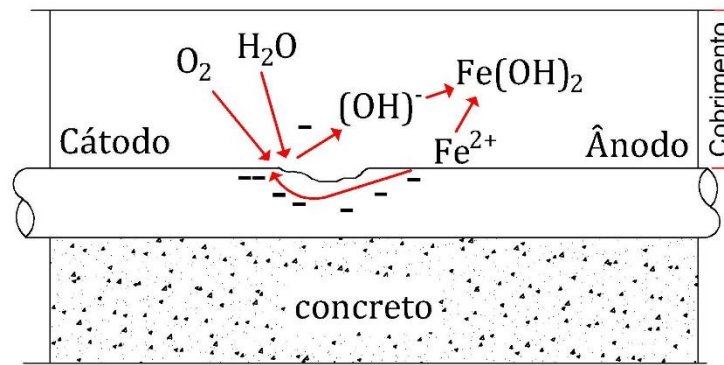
Processo de corrosão da armadura em estruturas de concreto armado.
